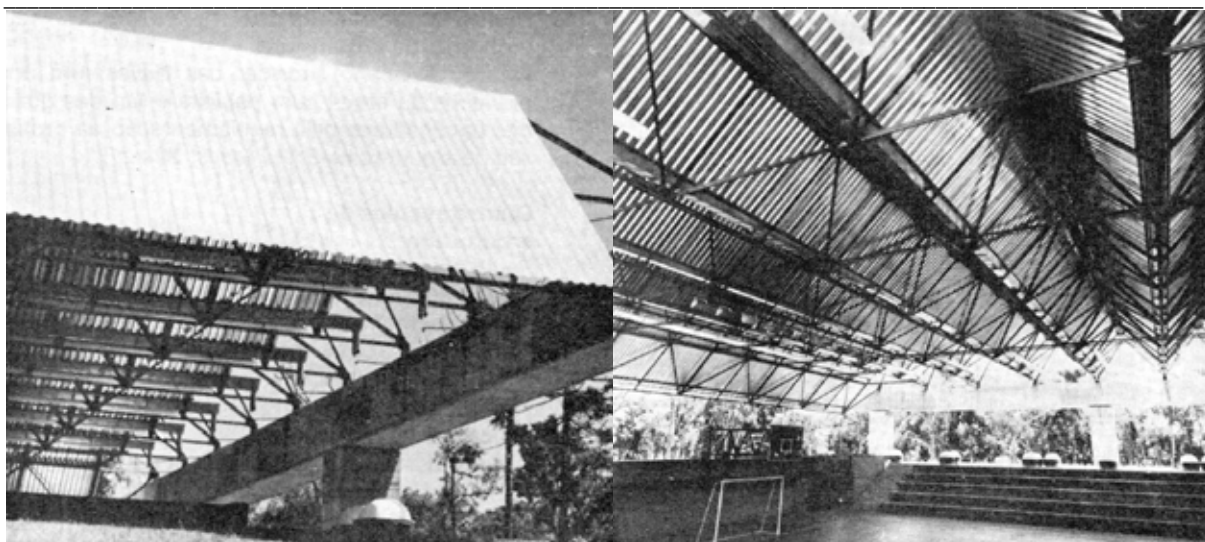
vista aproximada do sistema estrutural constituído por viga/pilar em concreto aparente. Observar que treliças metálicas tridimensionais descansam contra as duas travessias laterais, de modo a poder suportar as coberturas em chapa ondulada de alumínio.
